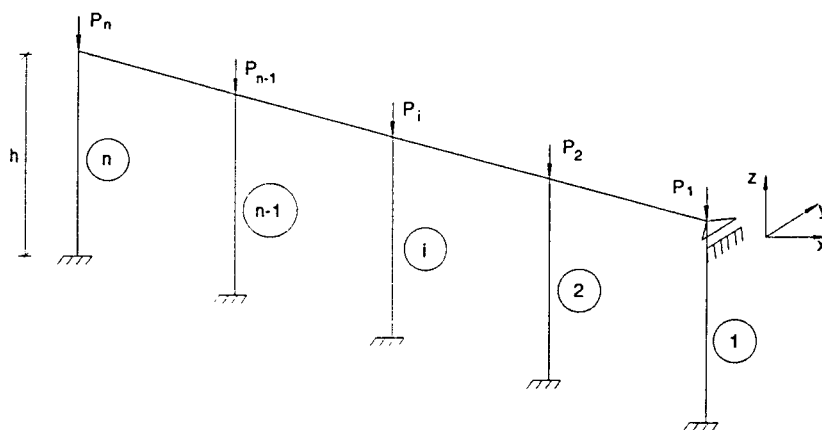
Estrutura plana - 1 andar - n pilares.
